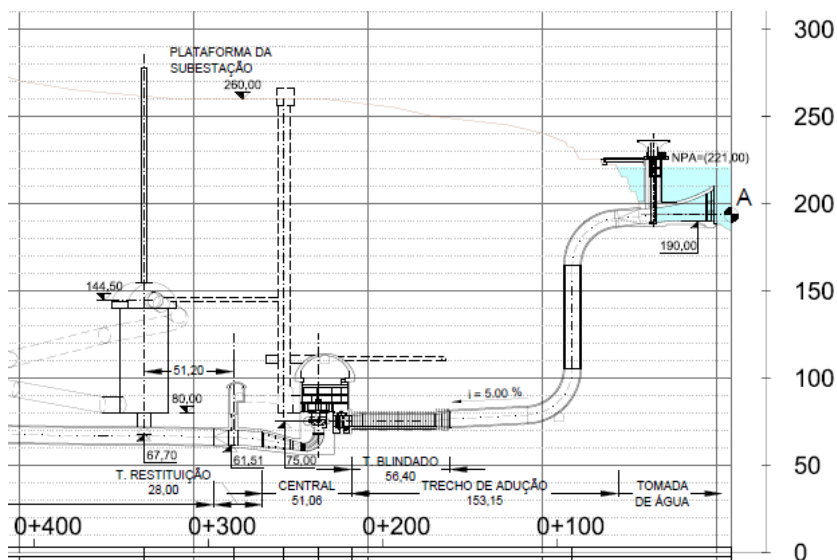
Perfil pormenorizado dos elementos construtivos [9].
